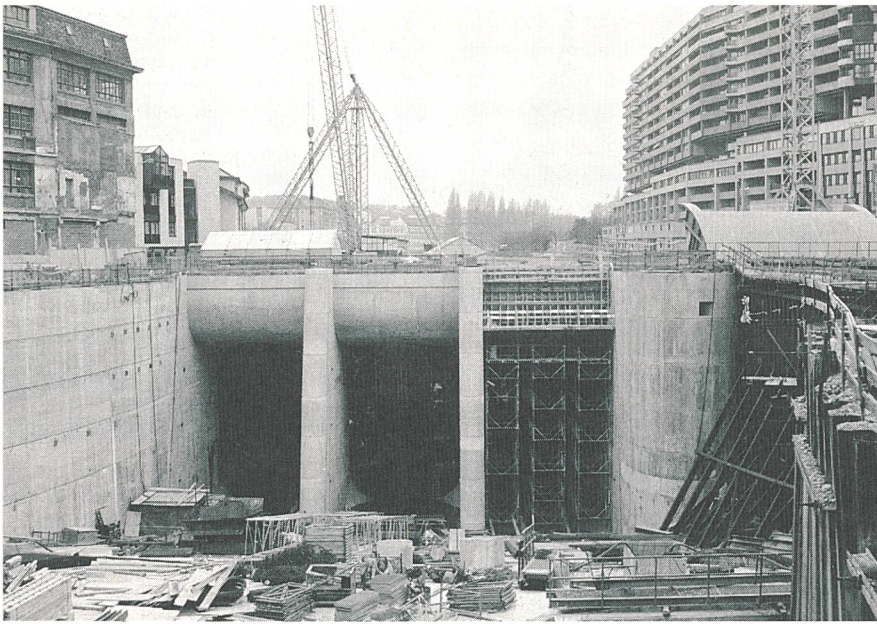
Canal d'entrée aux trois nouveaux groupes bulbes de chacun 2,9 MW de puissance
